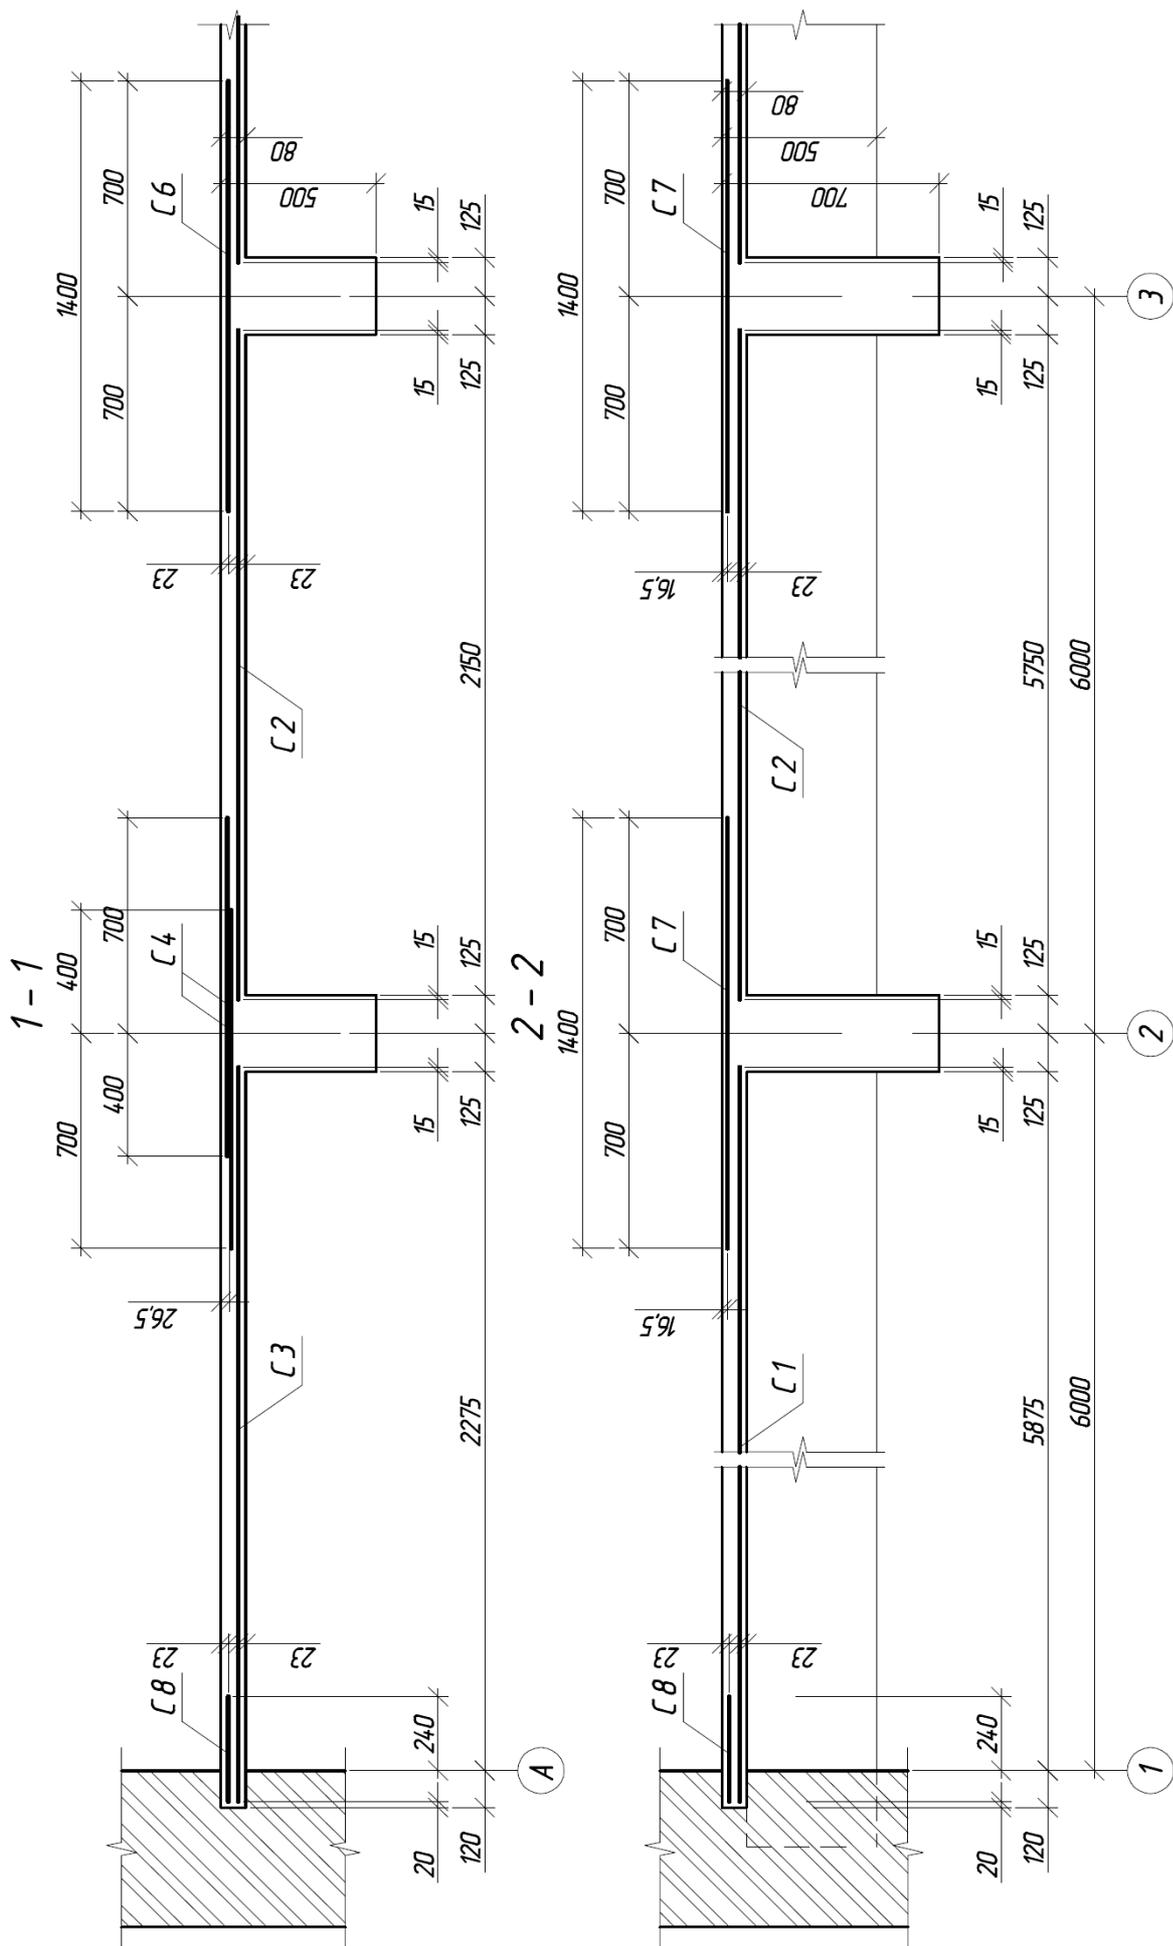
Разрезы 1-1 и 2-2 к планам верхних и нижних сеток
